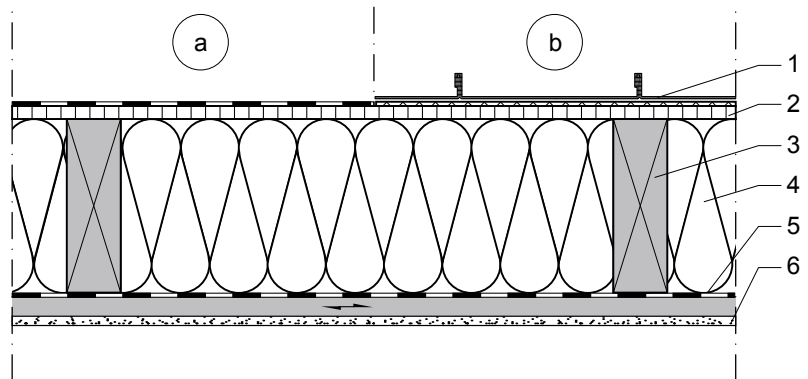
Nachweisfreie einschalige Flachdachkonstruktion GK 0
